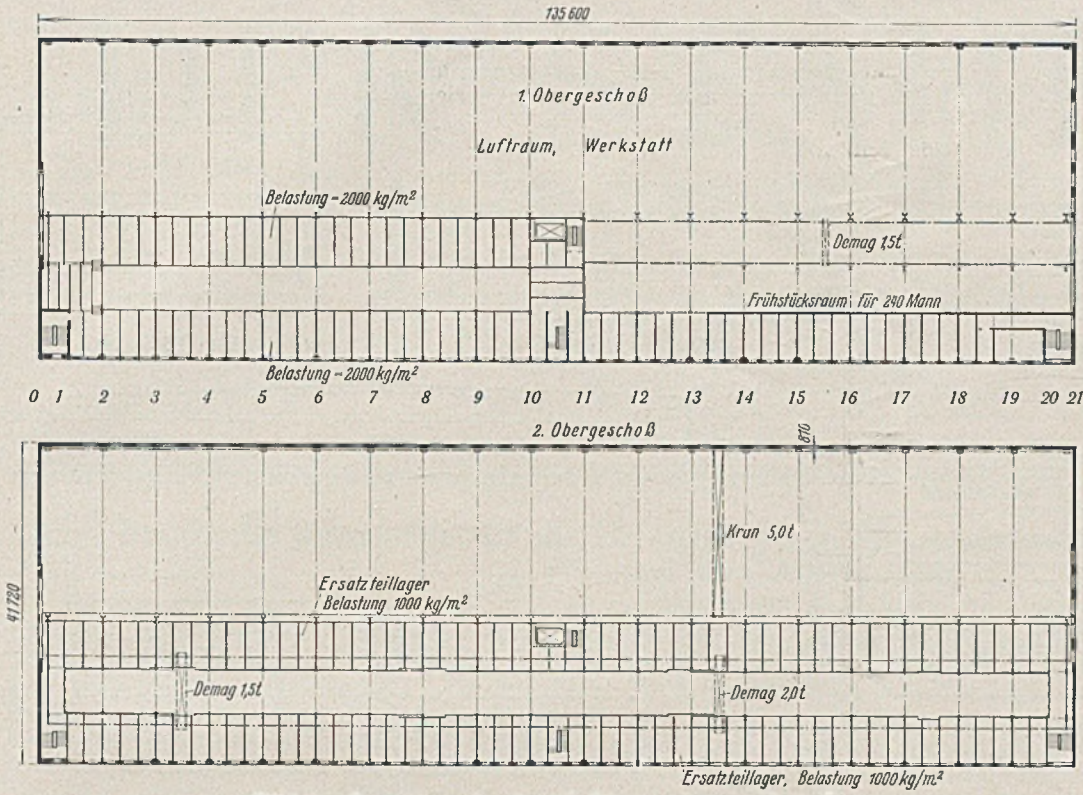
Grundrisse des 1. u. 2. Obergeschosses Halle 7.
